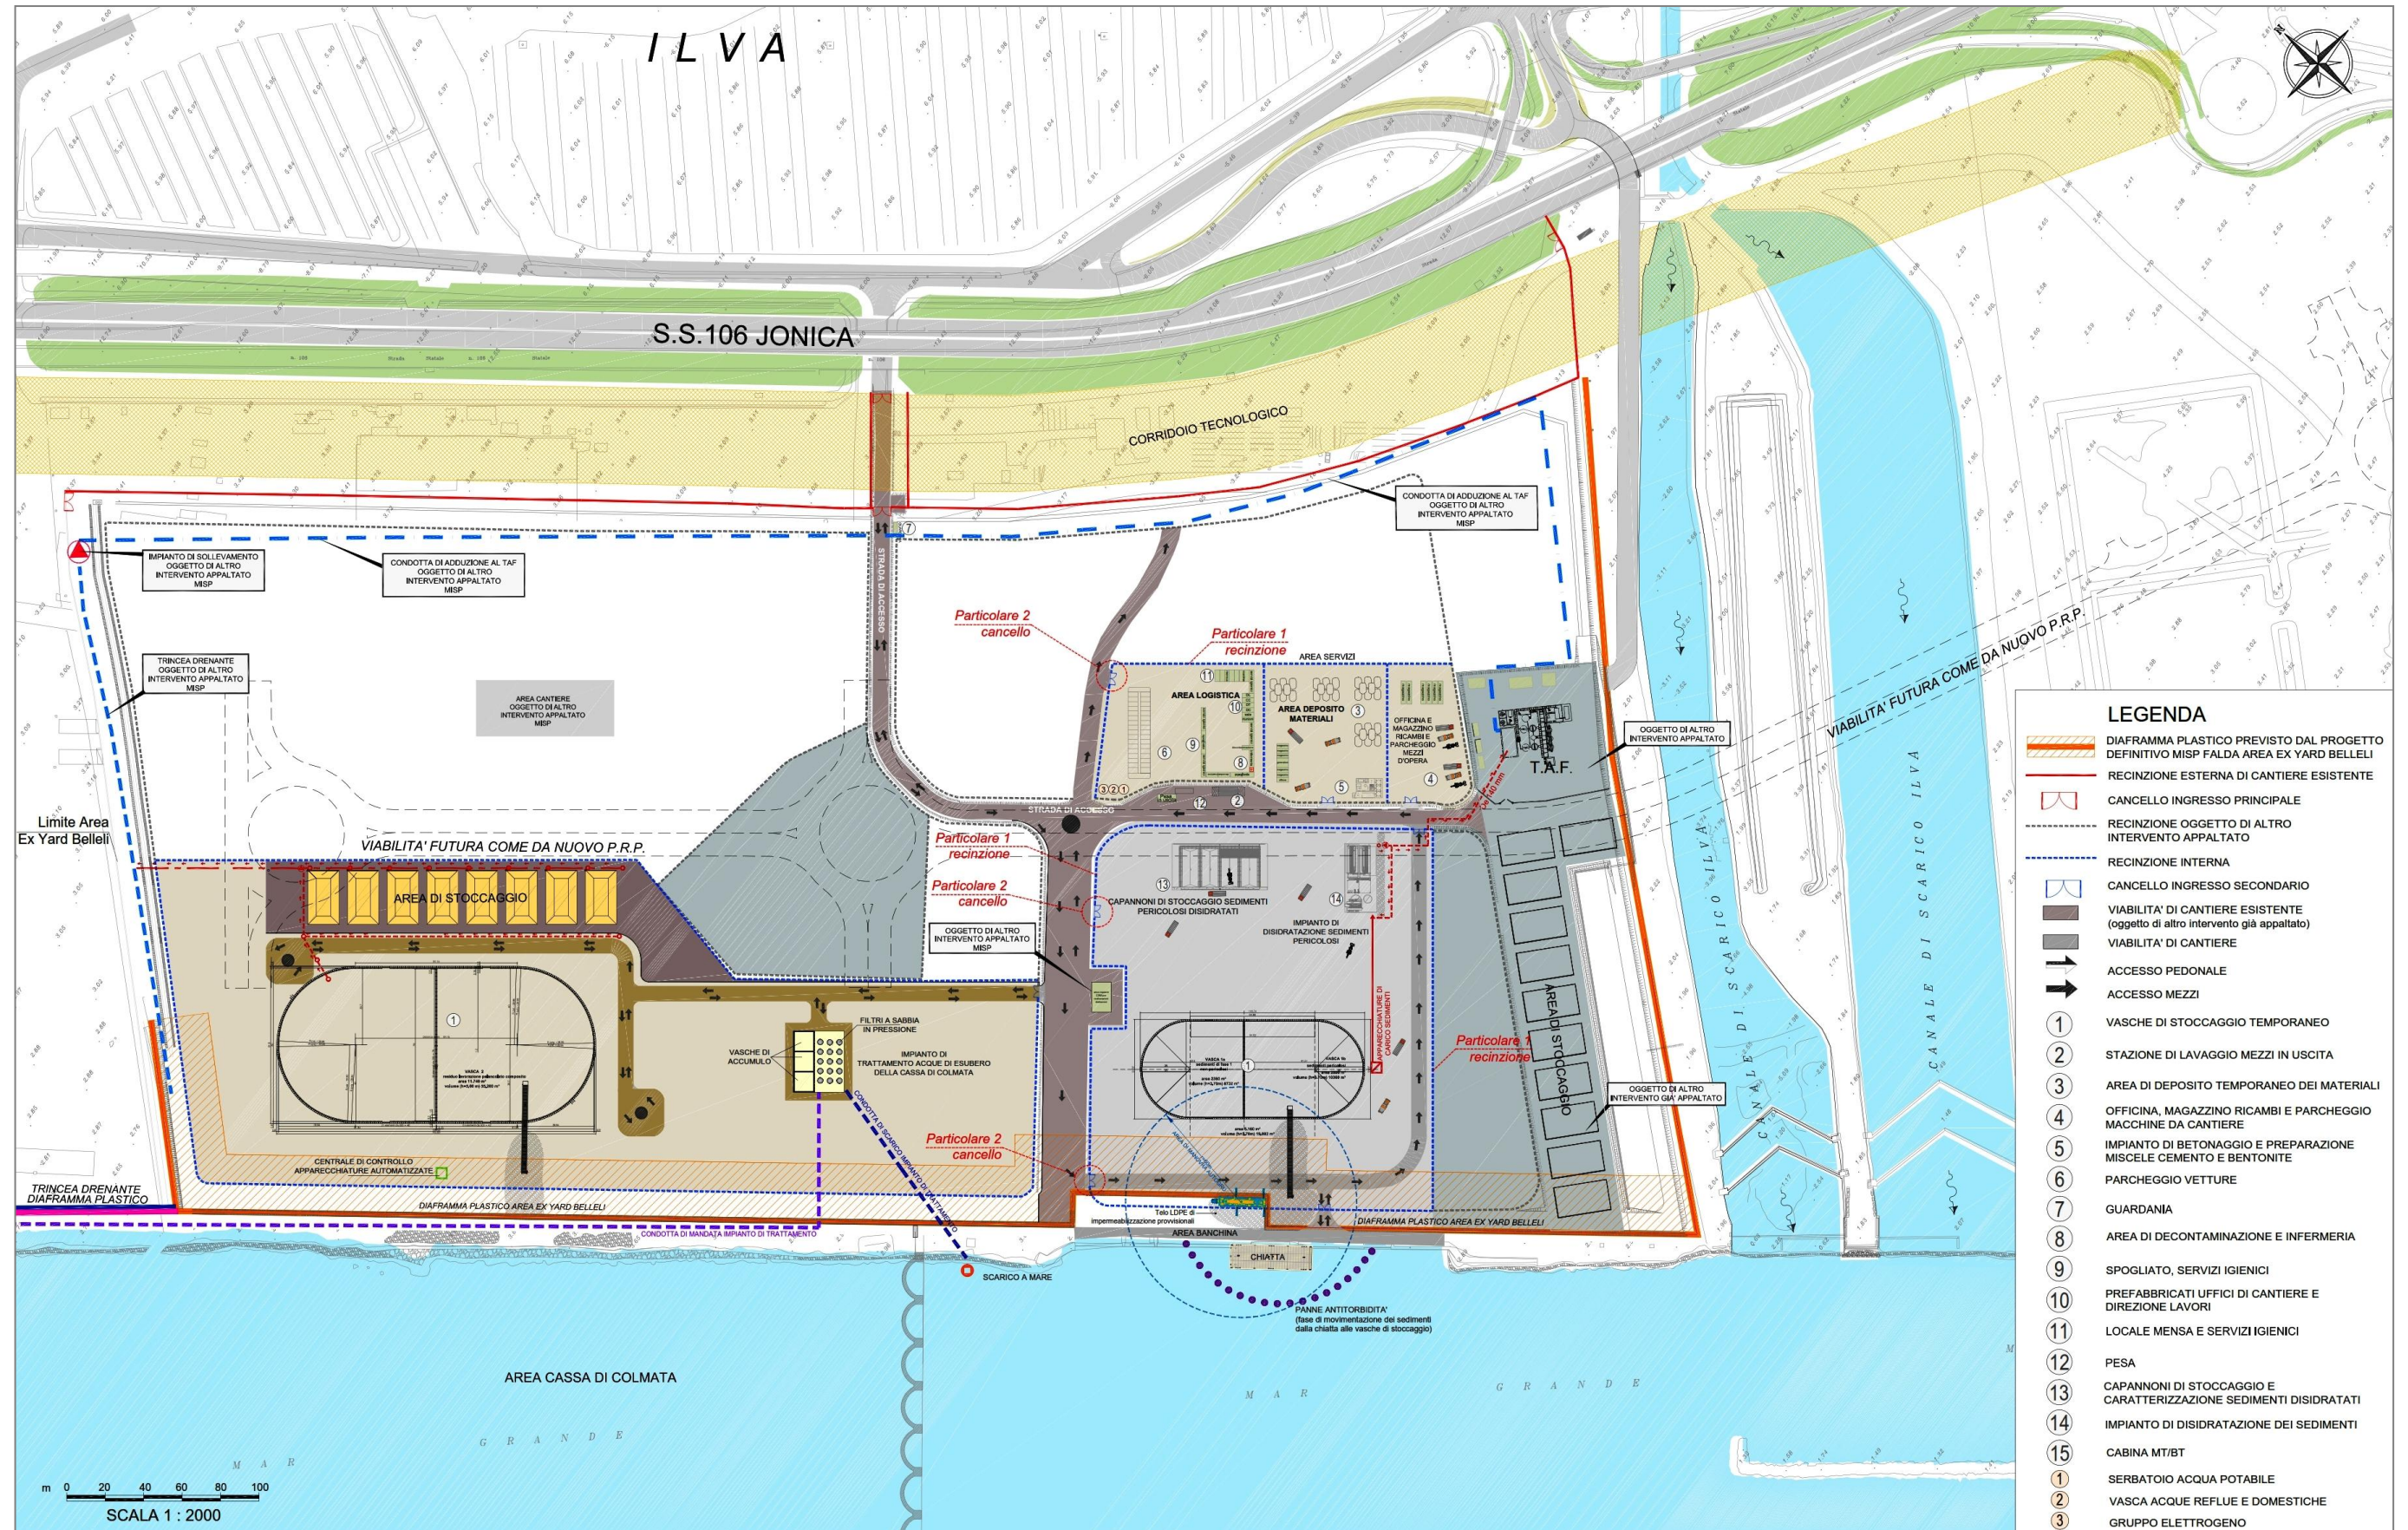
Planimetria generale dell'area di cantiere e dell'area logistica.
